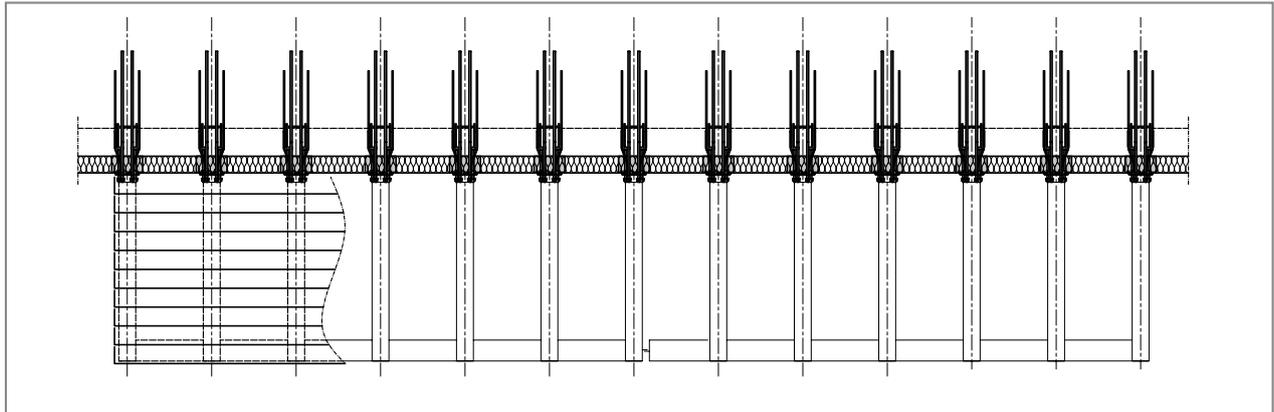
Schöck Isokorb® XT Typ SK: Balkon frei ausragend
